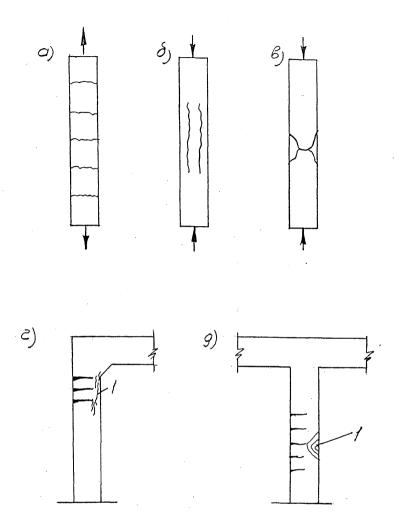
Трещины при разрушении железобетонных элементов а - центрально-растянутого; б,в - центрально-сжатого; г,д внецентренно- сжатого; 1 - участок раздробления бетона
